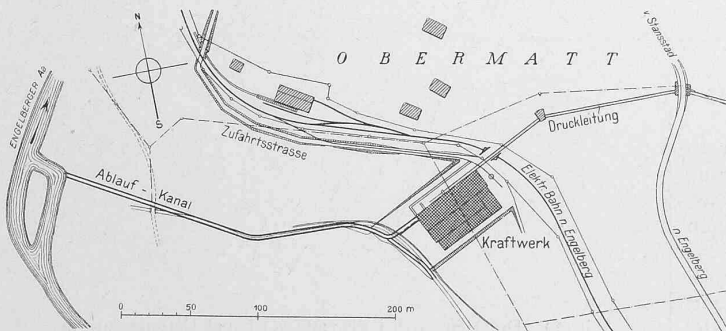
Lageplan der Kraftwerk-Anlage in Obermatt. — 1 : 5000.
